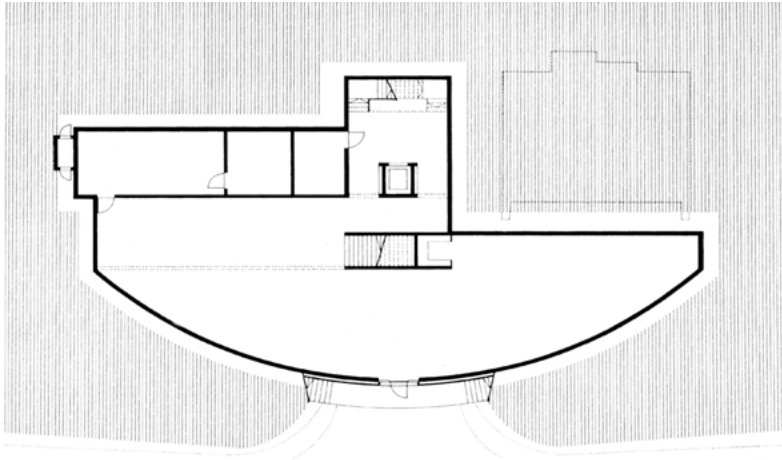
Mario Botta: Grundriss des Centre Dürrenmatt. Unterstes Geschoss mit dem großen Ausstellungsraum, 1998)
